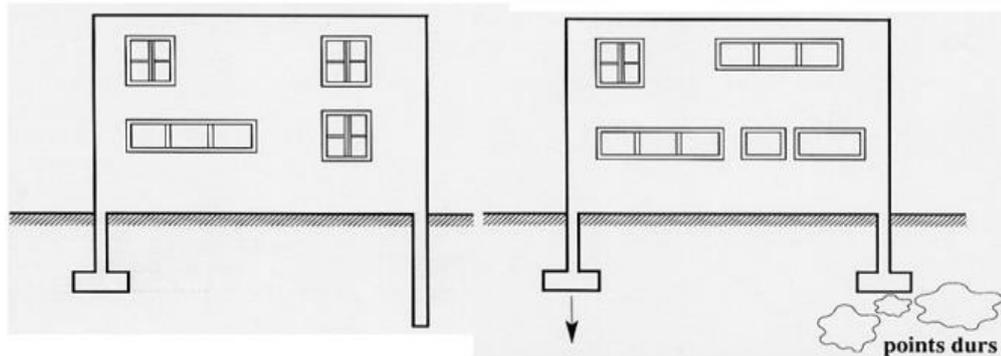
Fondations différentes et profondeurs différents du projet.
